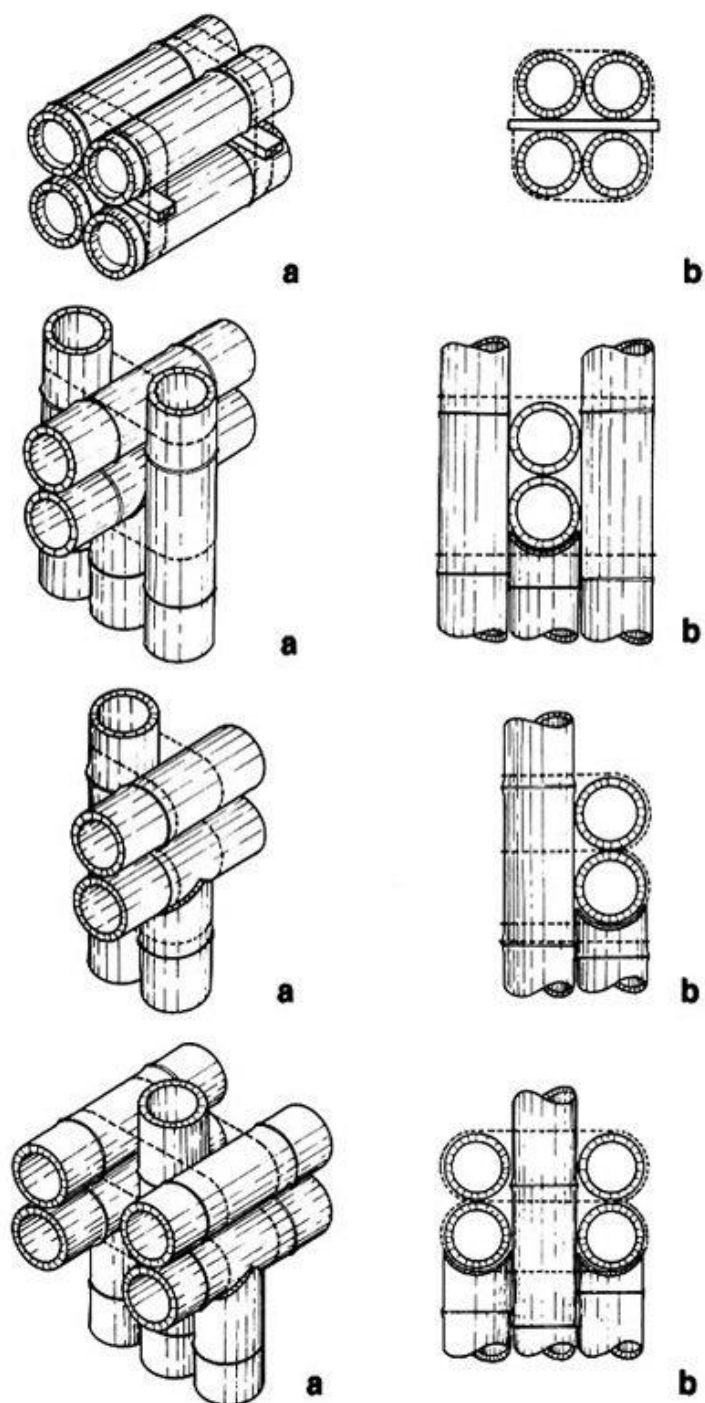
Pormenor estrutura de Bambu¹⁰⁴
